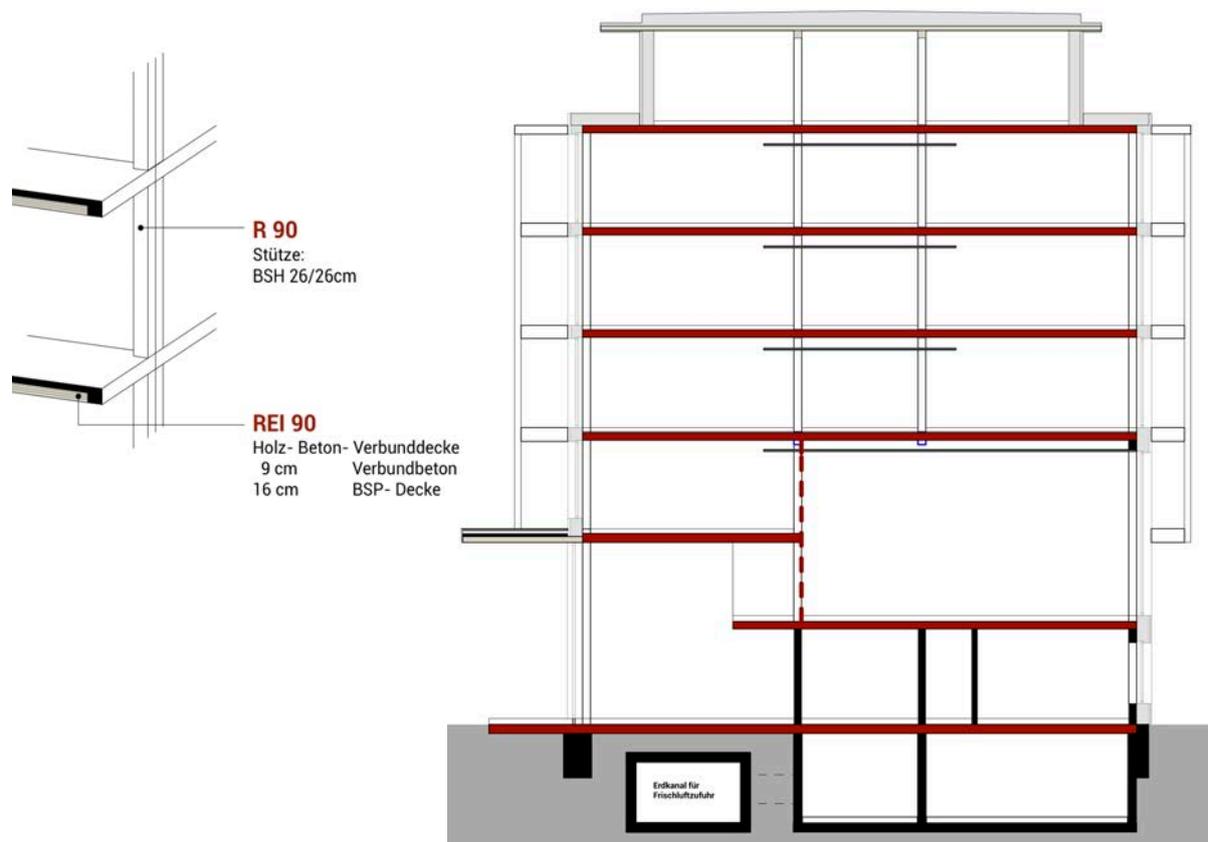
Tragwerk- Erfüllung der Brandschutzanforderungen bei sichtbaren Holzoberflächen durch Überdimensionierung der BSH Stützen und geschoßweise Brandabschnittsbildung mit der Holz- Beton Verbunddecke; © Bernhard Bauer
